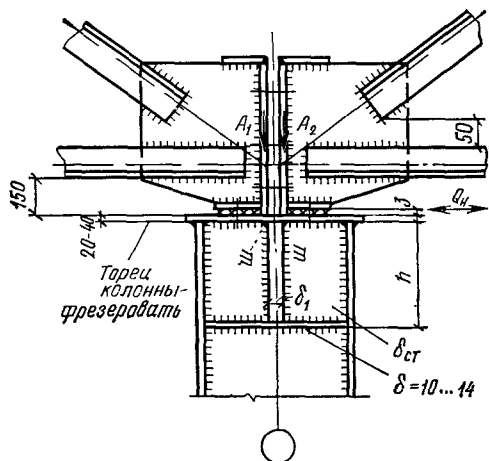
Шарнирное опирание стропильных ферм на колонну
